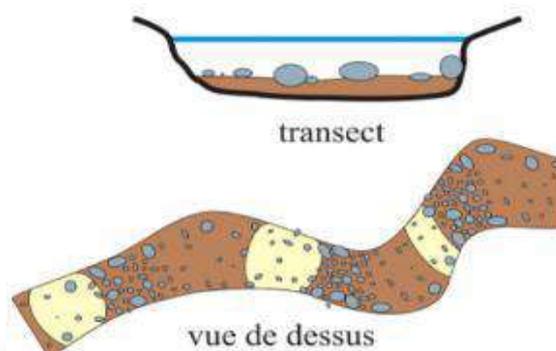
Mise en place de pierres et cailloux avec alternance de seuils et mouilles
